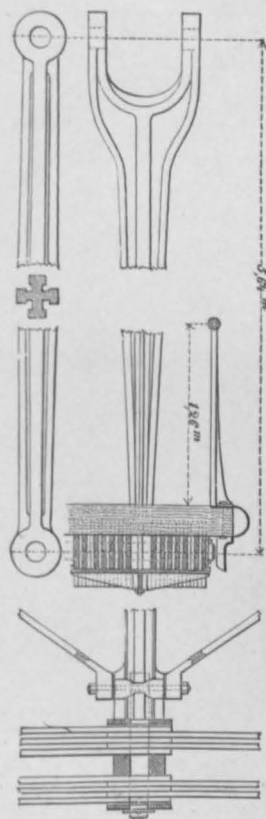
Druckstreben und Untergurt der Trentbrücke bei Newark. CUBITT. 1851.
